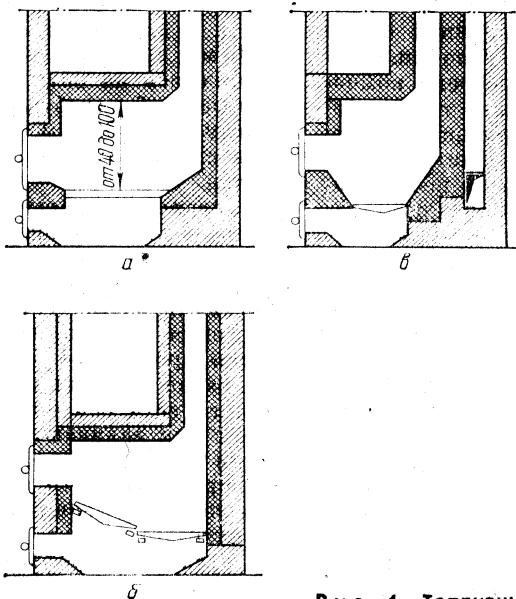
Топливники для различных видов топлива: а — для дров; б — для торфа; в — для каменного угля
